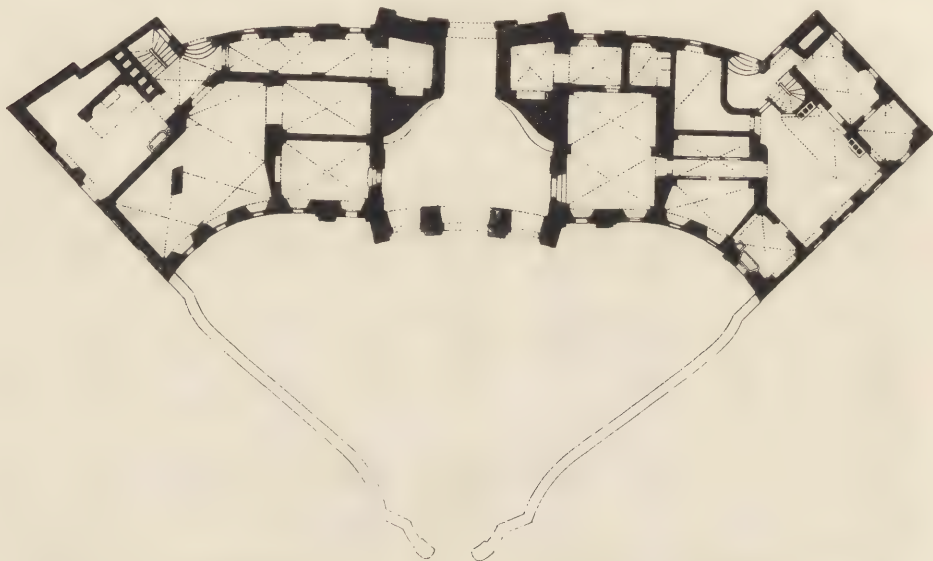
Erdrostenhof zu Münster i. W. Grundriss des Erdgeschosses.
